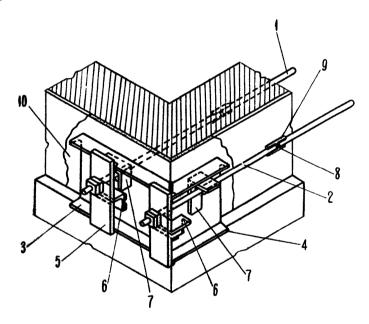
Схема усиления цокольного пояса стены парными стальными тяжами и устройства углового обжимного элемента:
